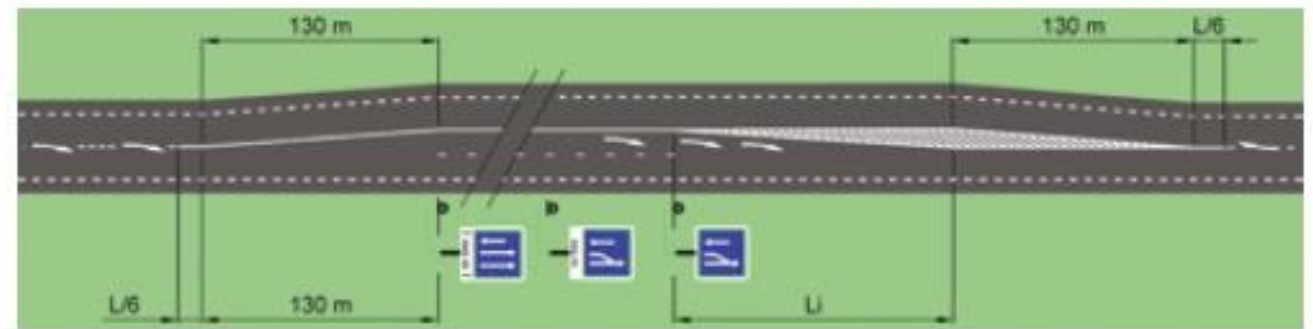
Schéma de construction d'un créneau de dépassement – ARP 2022
